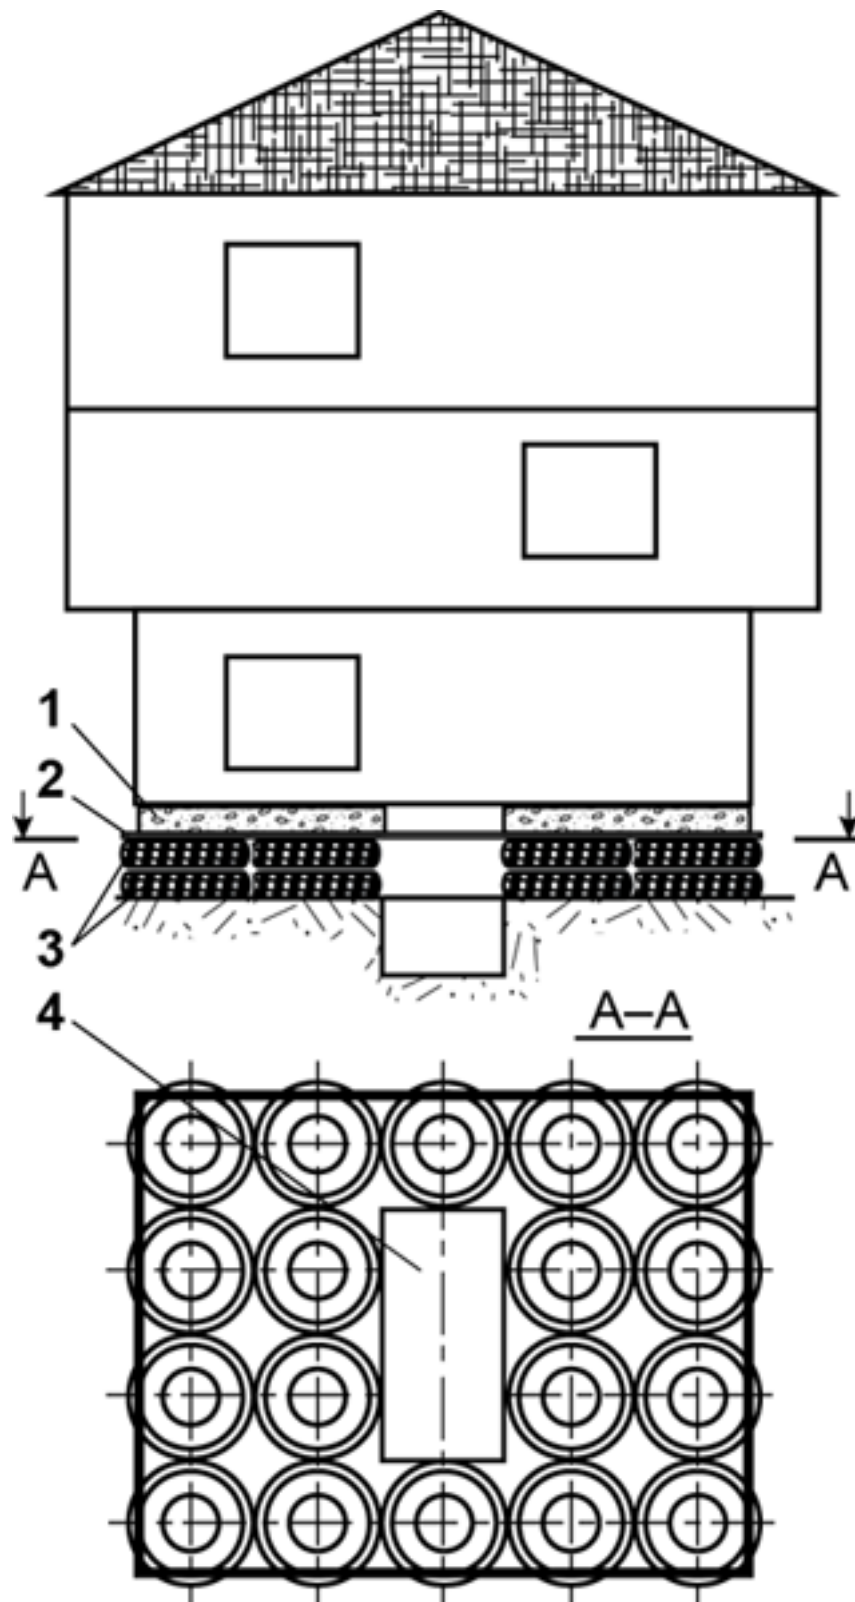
Терем на фундаменте из покрышек: 1 – бетонная плита; 2 – линолеум (рубе-роид); 3 – покрышки; 4 – подполье
